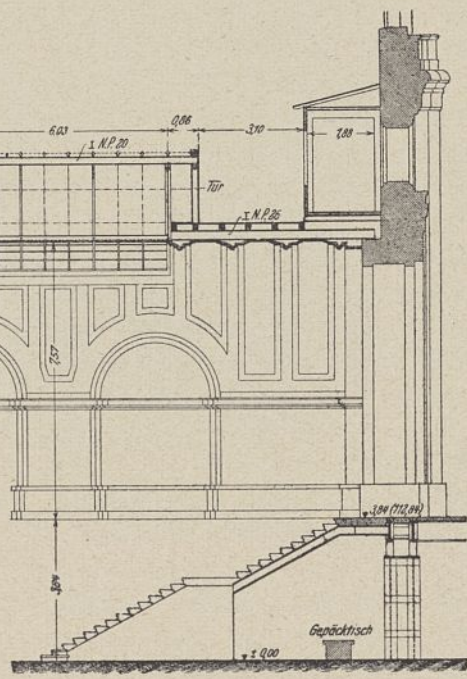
Längsschnitt der Ausgangshalle. Maßstab 1:200.
